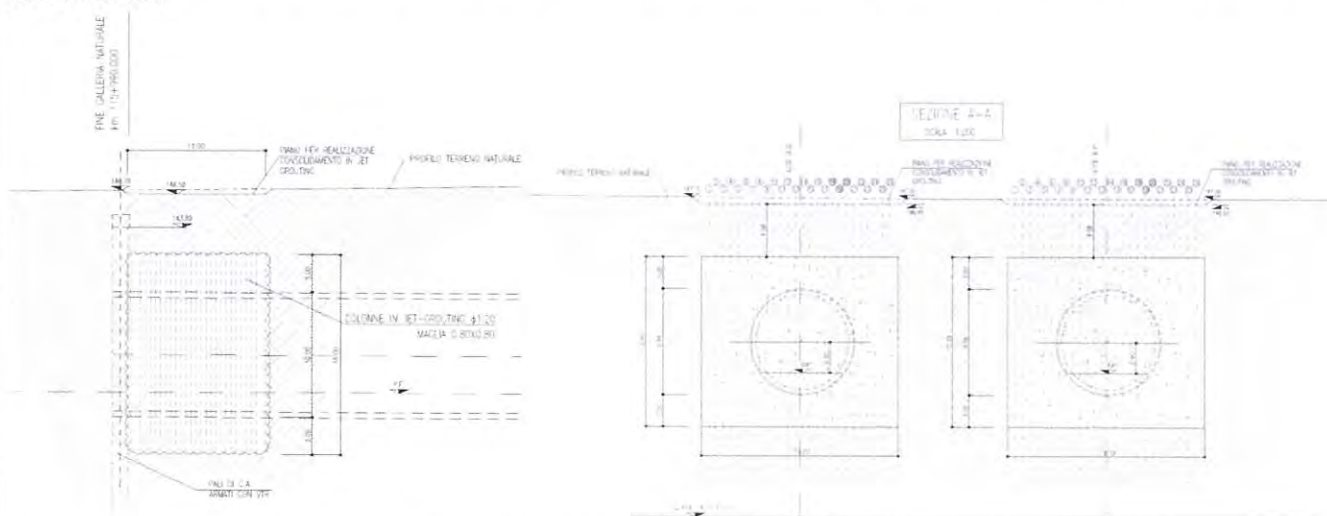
Profilo e sezione del consolidamento in jet-grouting a tergo delle paratie
